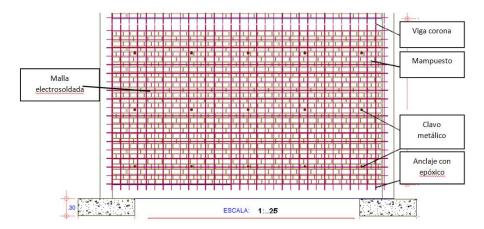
Detalles constructivos de la alternativa de solución propuesta reforzamiento con malla electrosoldada y pañete. Fuente: elaboración propia.
